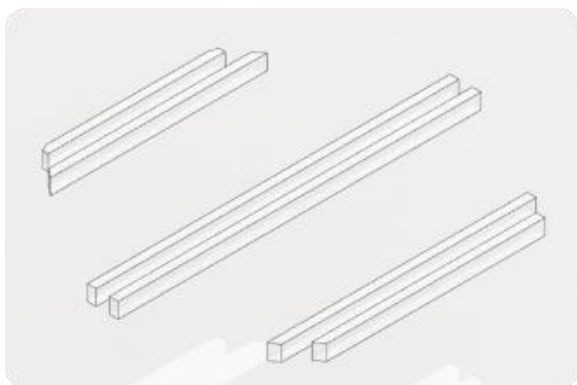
Vigas en pino impregnado, primer nivel de plataforma.
